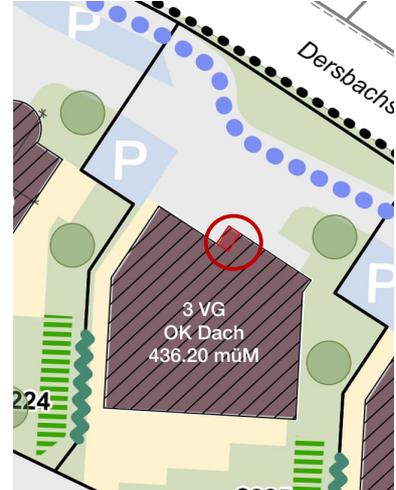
Überführter BBP (inkl. Gebäude gebaut in schwarz schraffiert, Vergrösserung Baubereich in roter Fläche)
